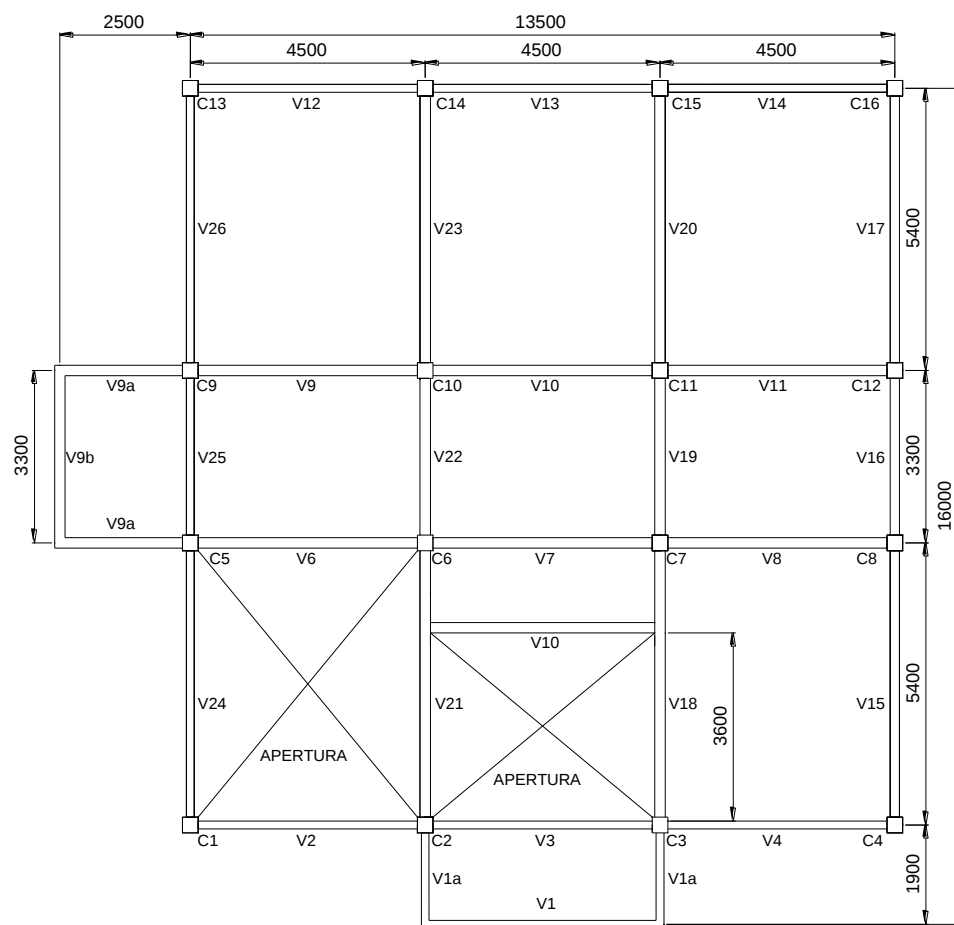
6 Disposición estructural de vigas y columnas del piso 1
